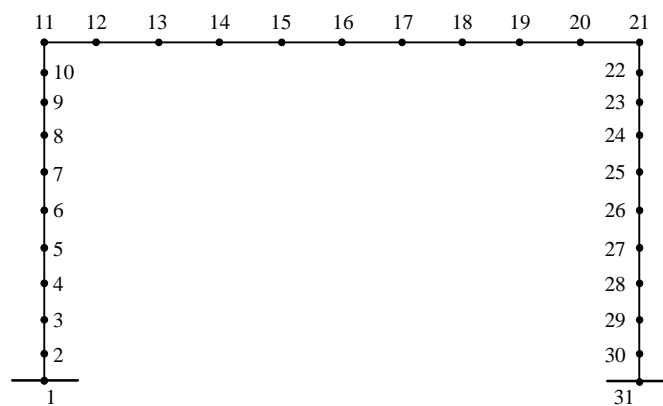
Discretização utilizada para o pórtico de um pavimento.
